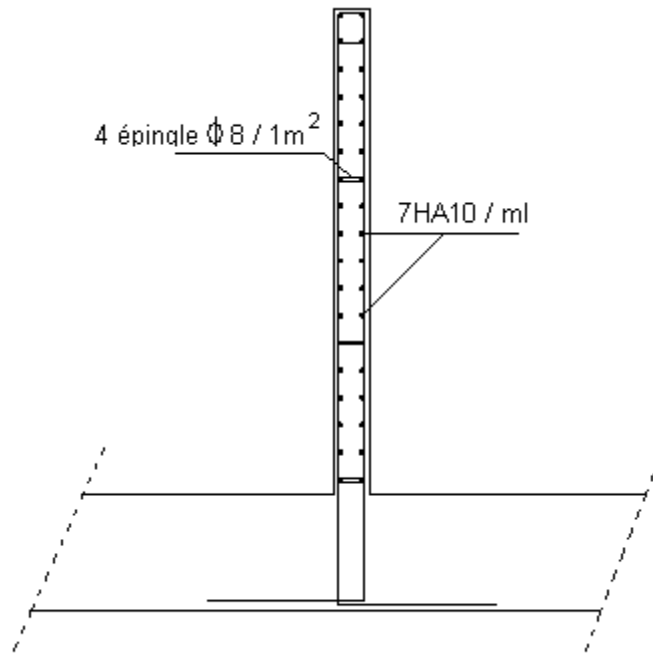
Schéma de ferrailage d'un mur périphérique.
